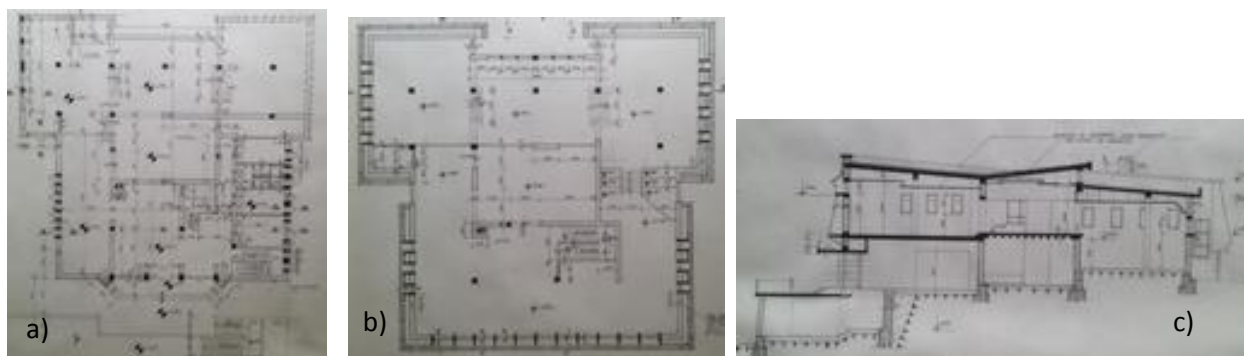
Muzeu “B. Curri”, Tropojë (ark. M. Mitrojorgji, I. Prushi, 1981). a) Planimetria e katit përdhe. b) Planimetria e katit të parë. c) Prerje.
